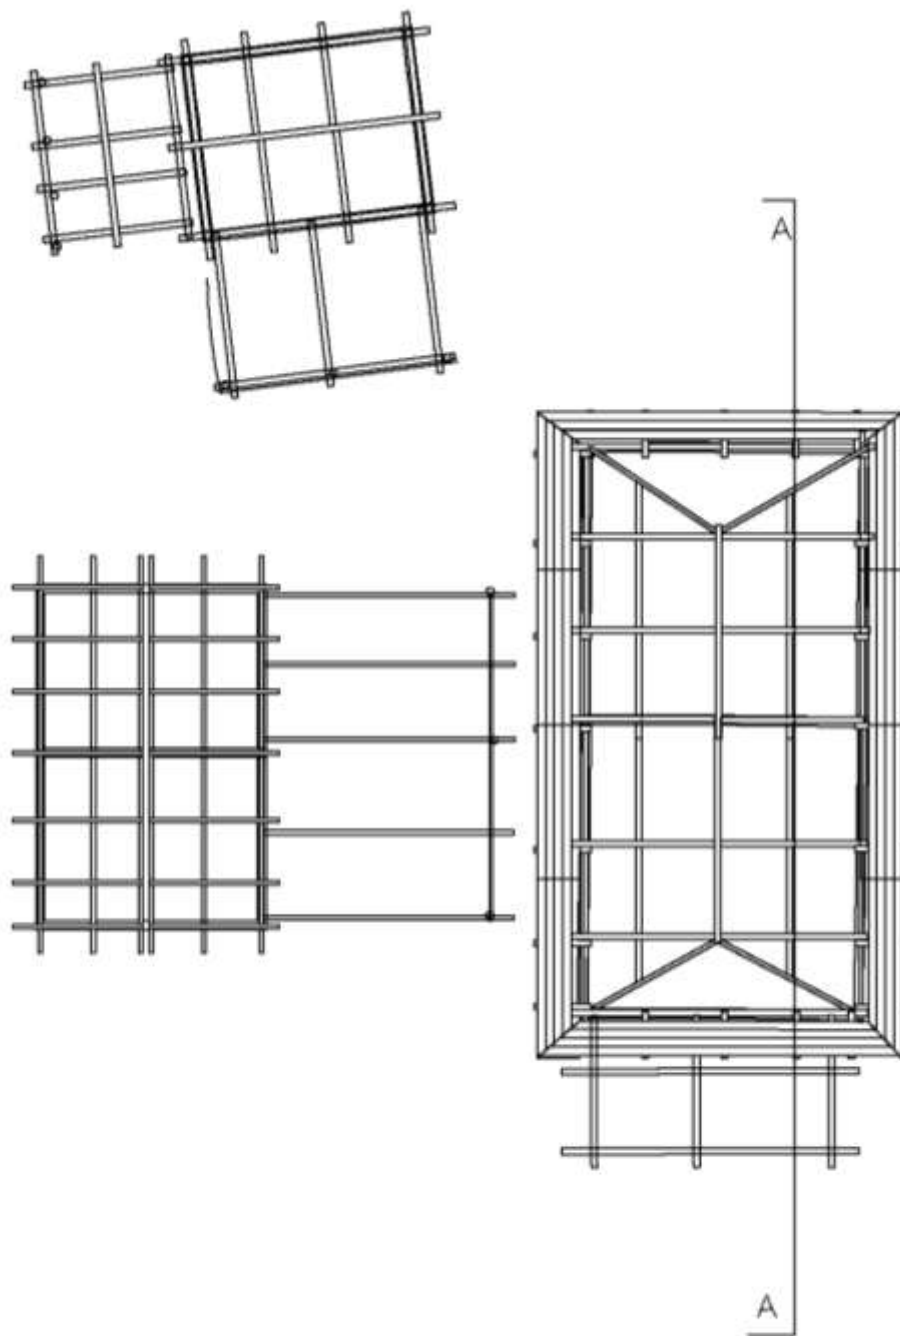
Planta estructura cubierta. Vivienda Rivas.
